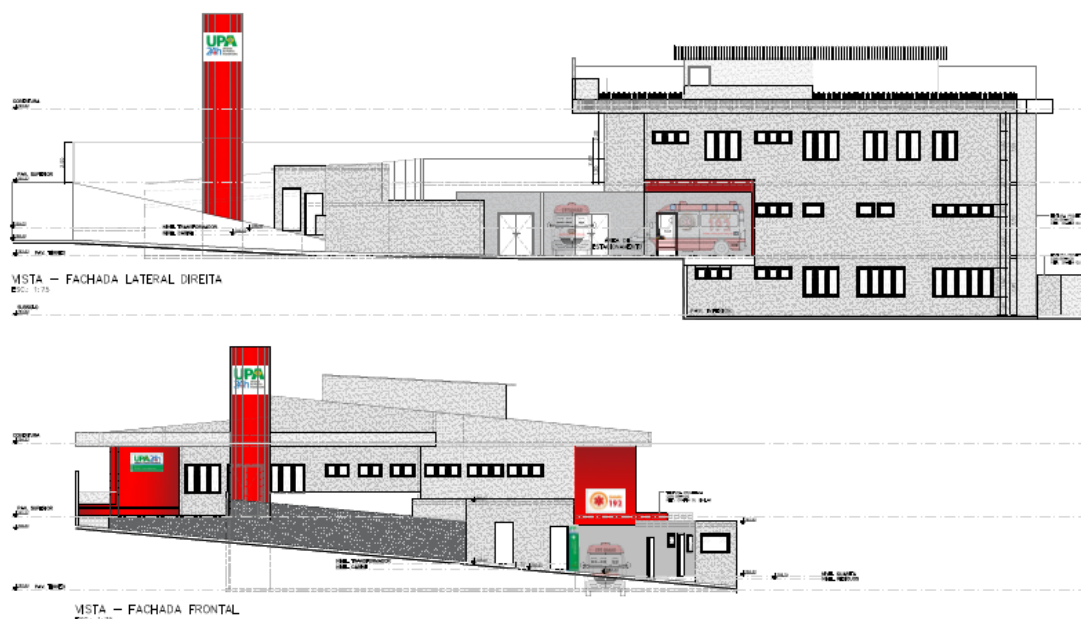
fachadas – Aproveitamento dos desníveis do terreno
